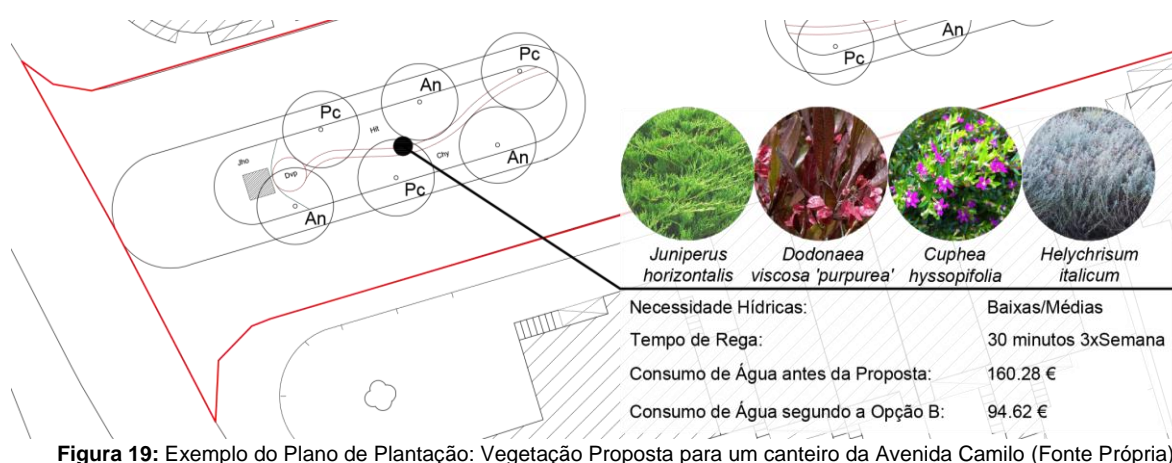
Exemplo do Plano de Plantação: Vegetação Proposta para um canteiro da Avenida Camilo (Fonte Própria)
